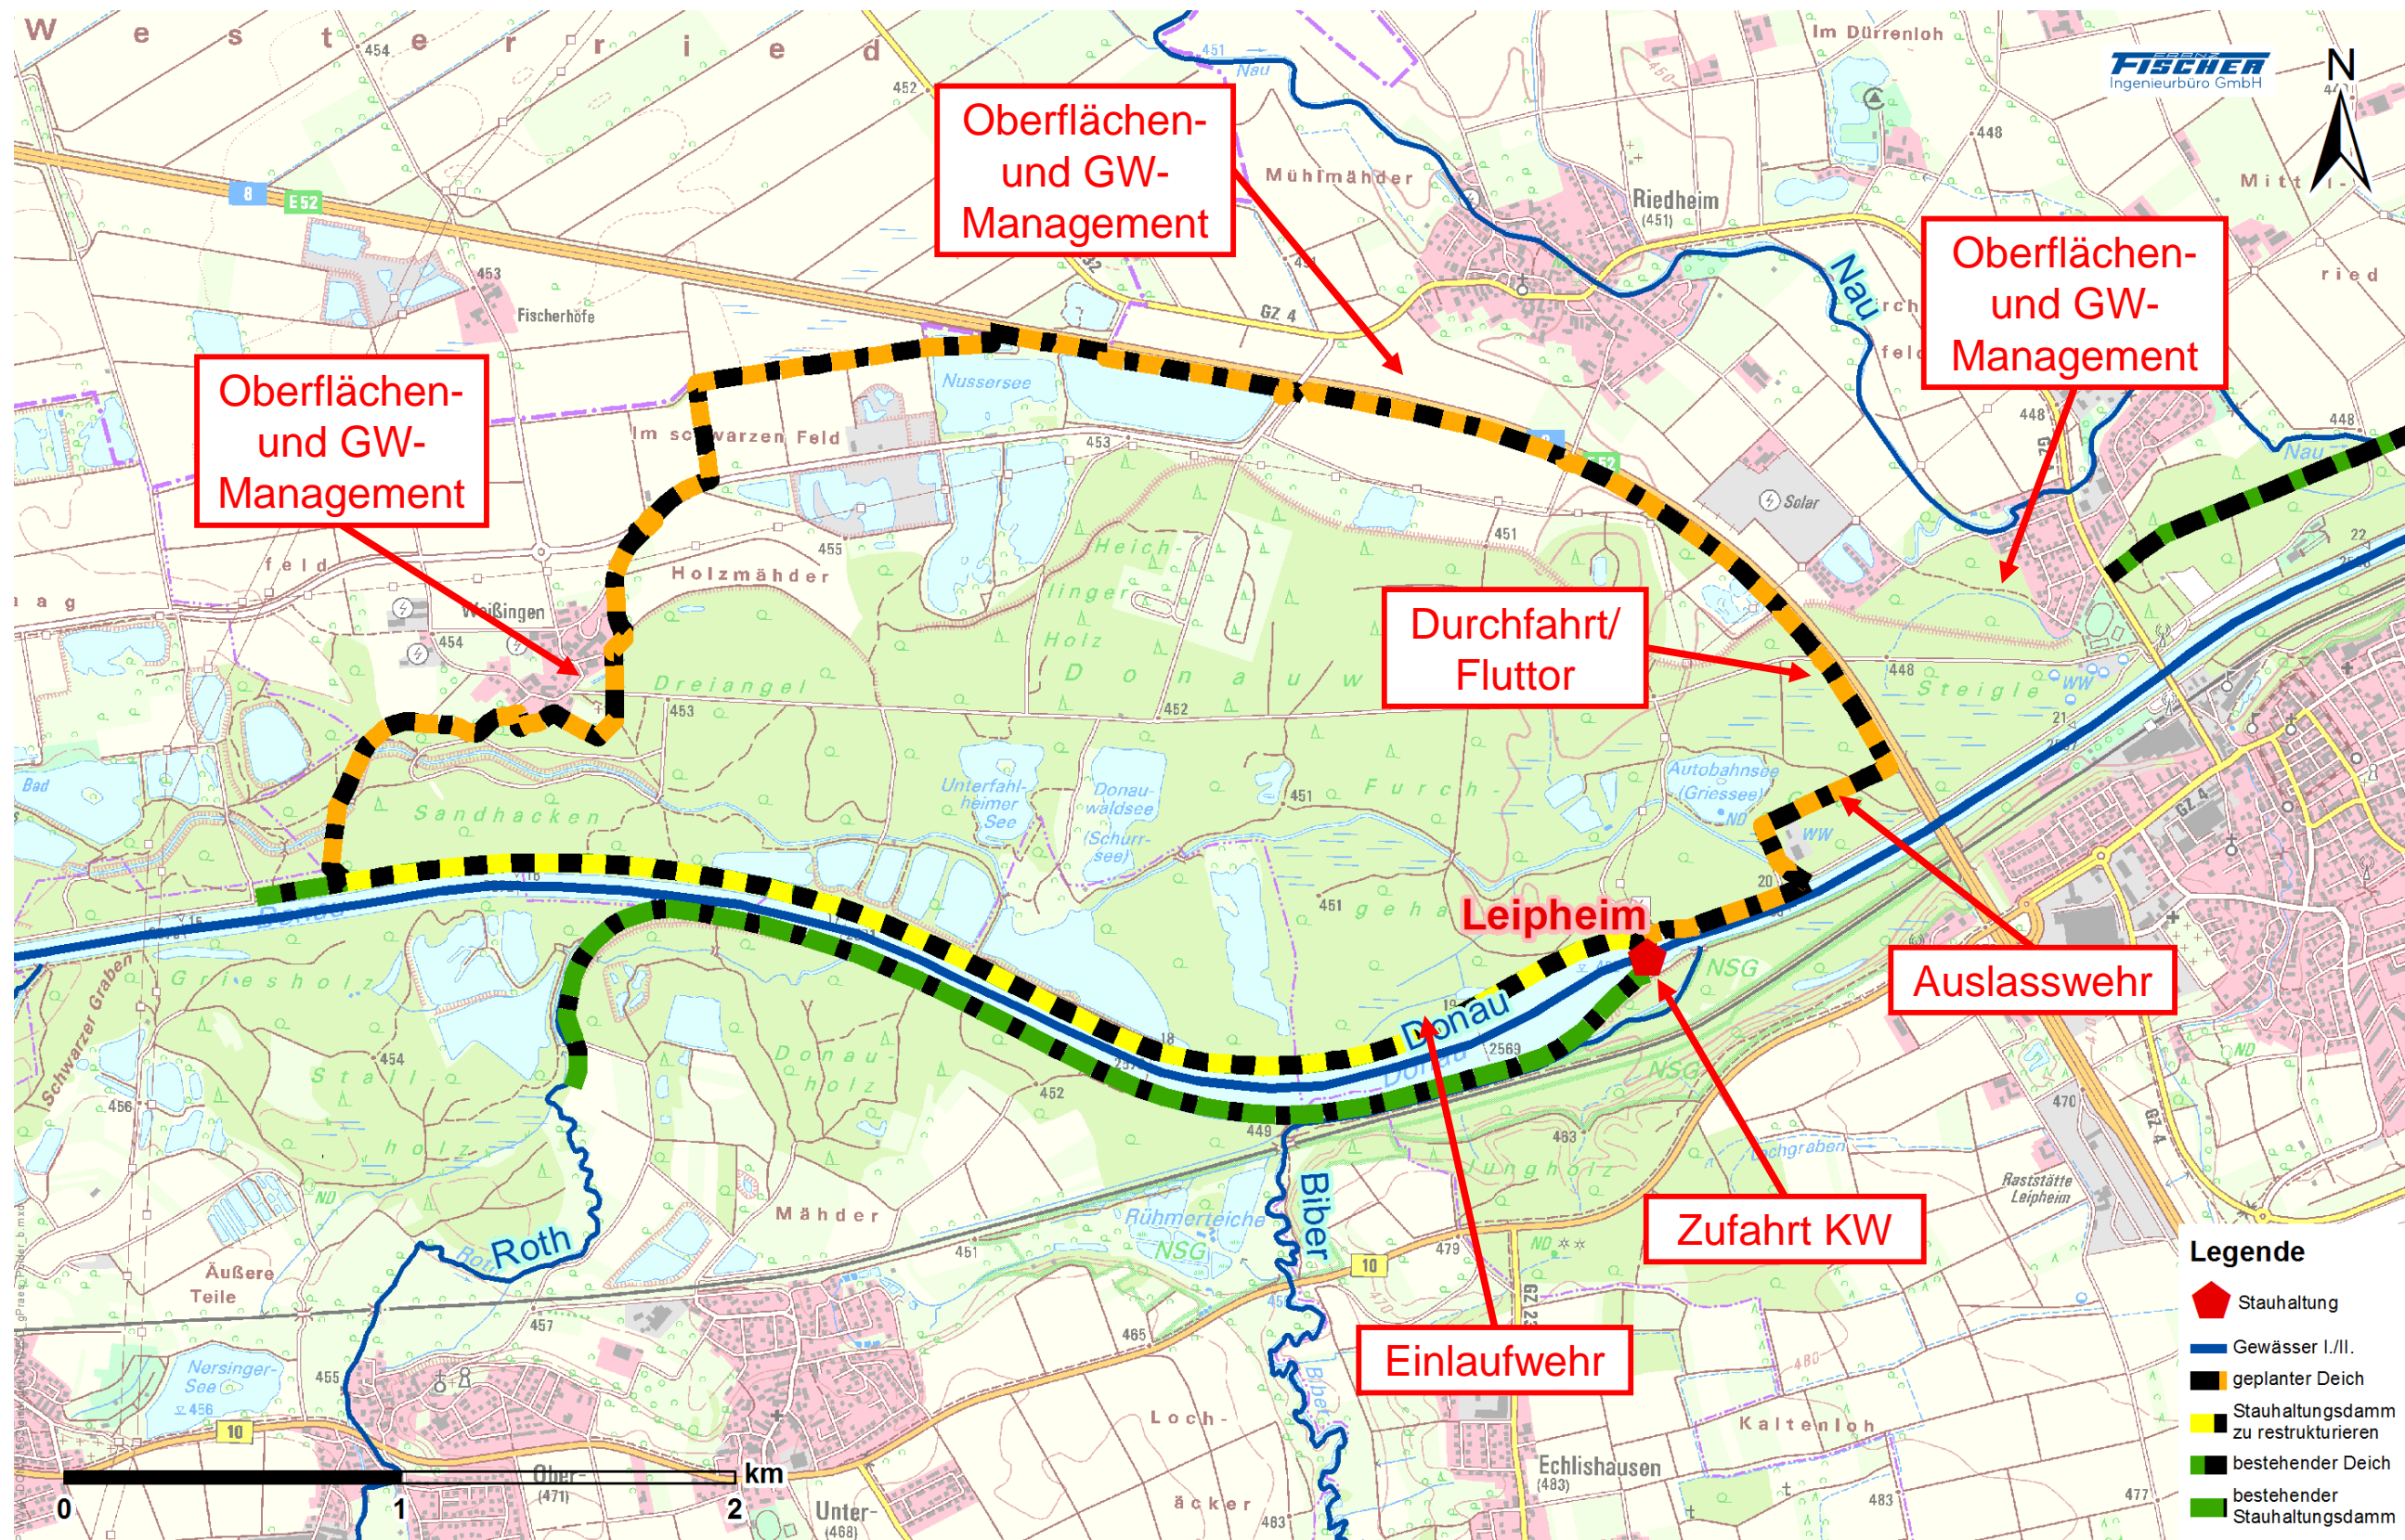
Lageplan des Polders Leipheim mit Einstau
